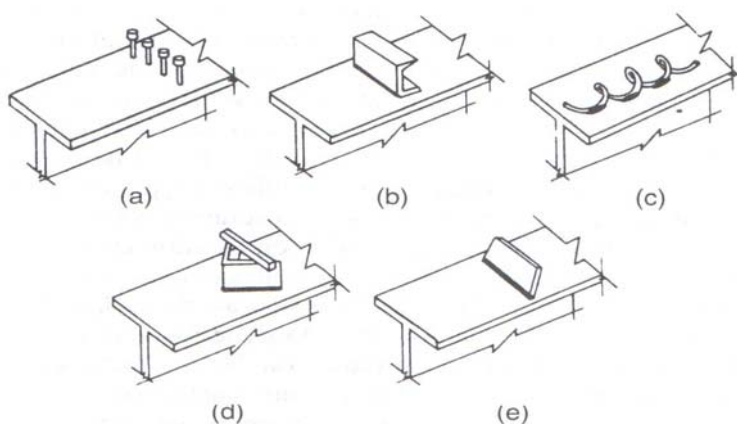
(a) *Stud Bolts* soldados; (b) perfis U; (c) espiral; (d) ângulo enrijecido; (e) barra inclinada plana
